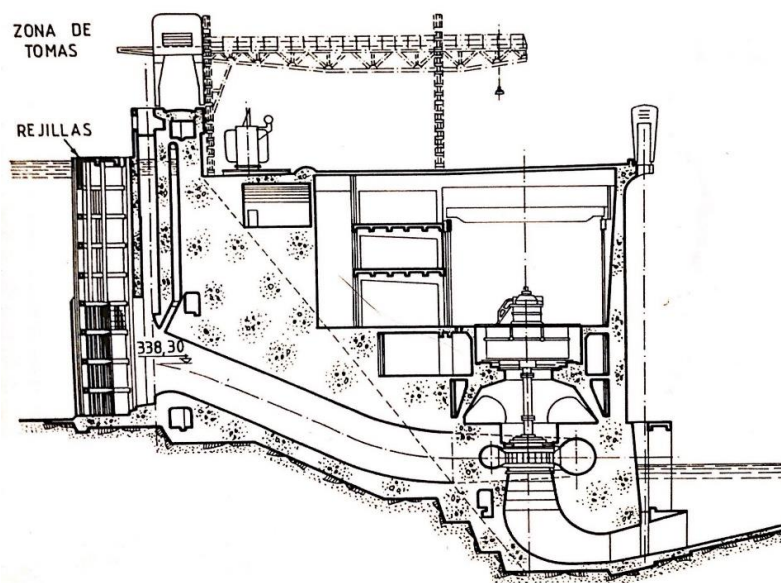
Sistema de conducción por tubería forzada directa. [19]
